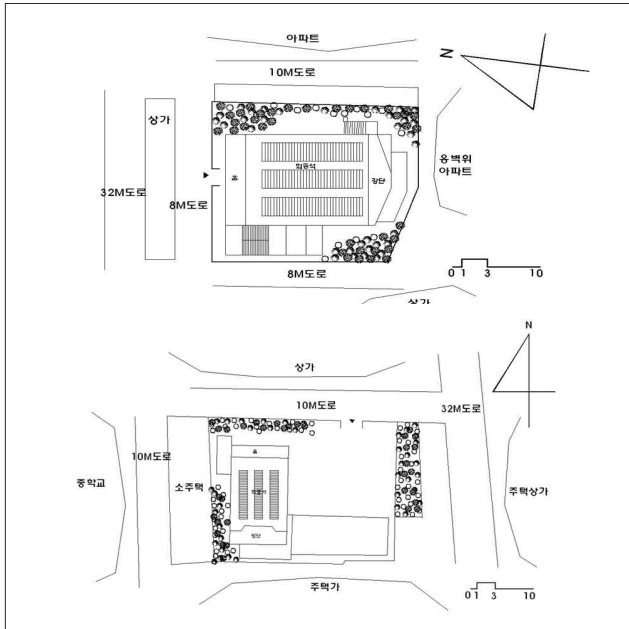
K(상) D1(하) 교회 배치도 및 평면도
